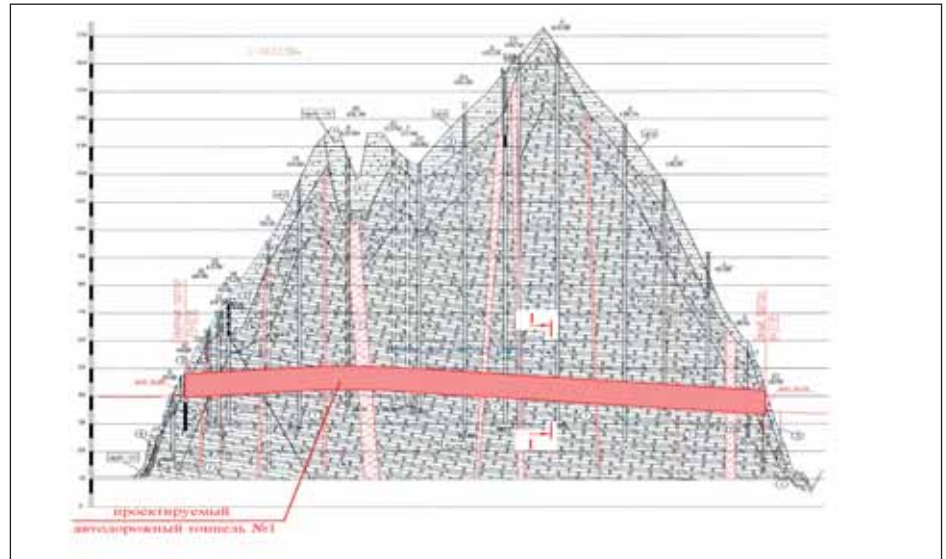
Расчетное сечение тоннеля № 1 на продольном разрезе
